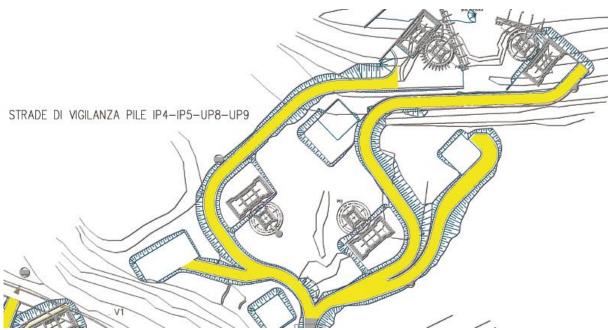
Stralcio planimetrico Strada di vigilanza Pile IP4 – IP5 – UP8 – UP9
